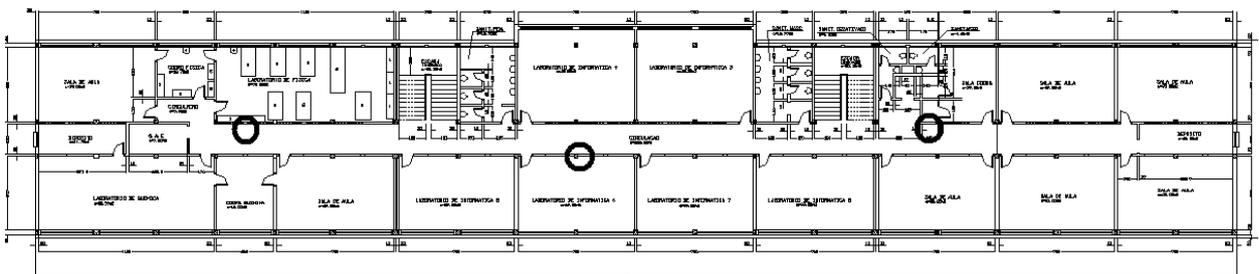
Localização recomendada para as tomadas de incêndio do quarto pavimento.
